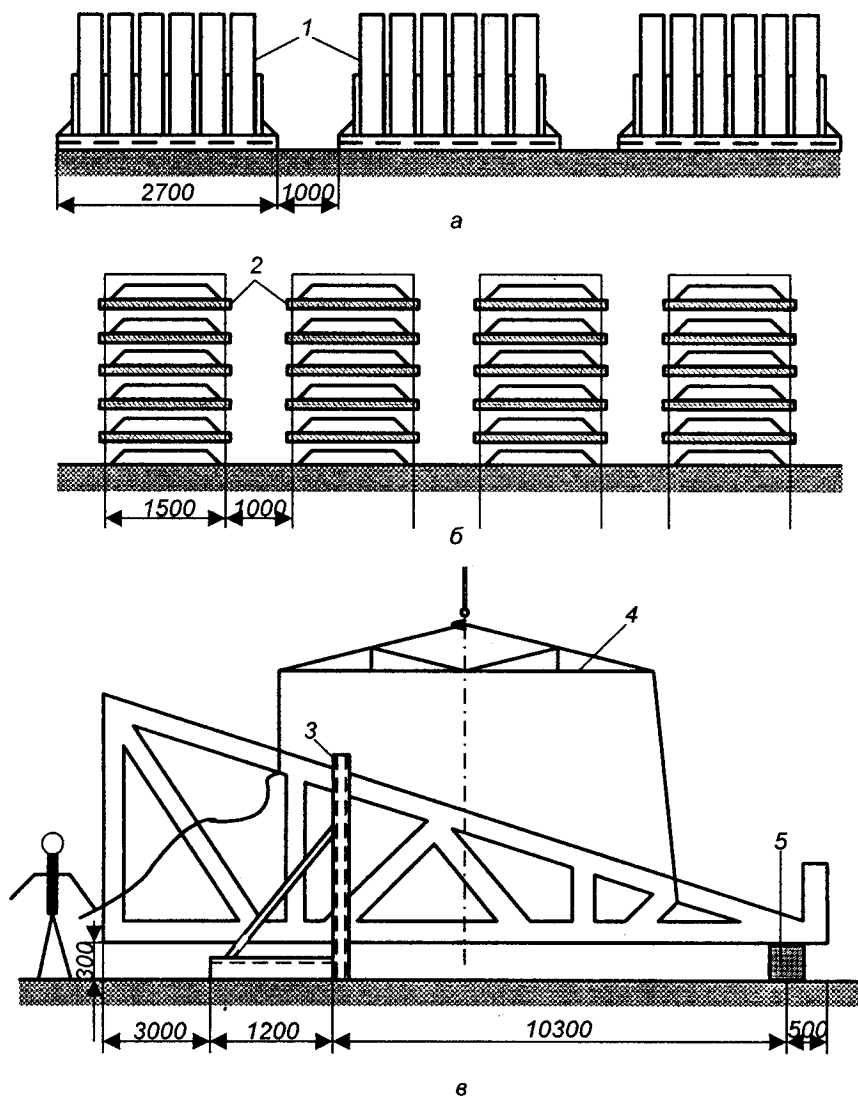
Складування залізобетонних конструкцій промислових будівель: а — стінні панелі в касетах; б — плити покриття; в — напівферми в касетах; 1 — стінні панелі; 2 — дерев'яні прокладки; 3 — касета; 4 — траверса; 5 — дерев'яна підкладка
